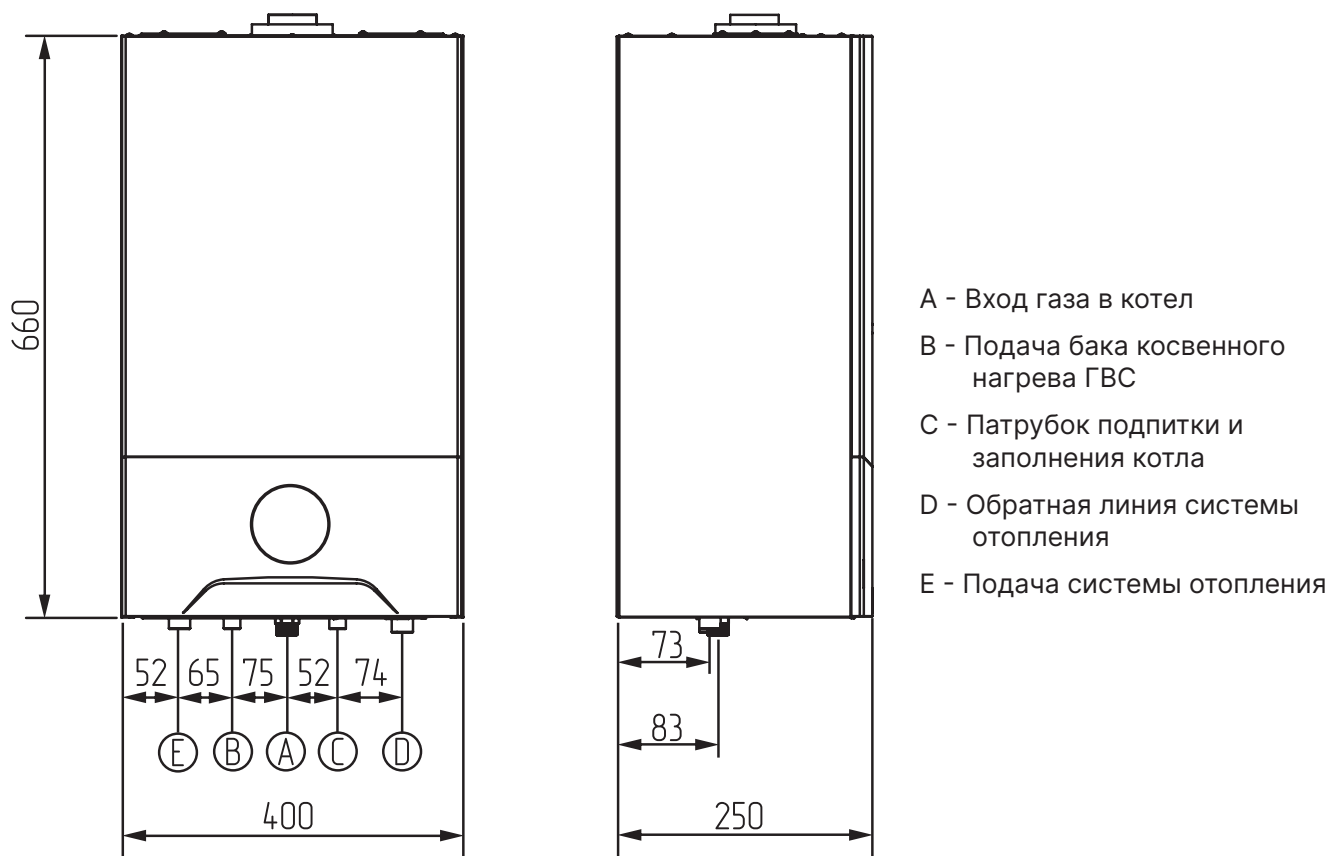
Габаритные размеры и обозначения котла ZOTA ZUMA 14S-24S
